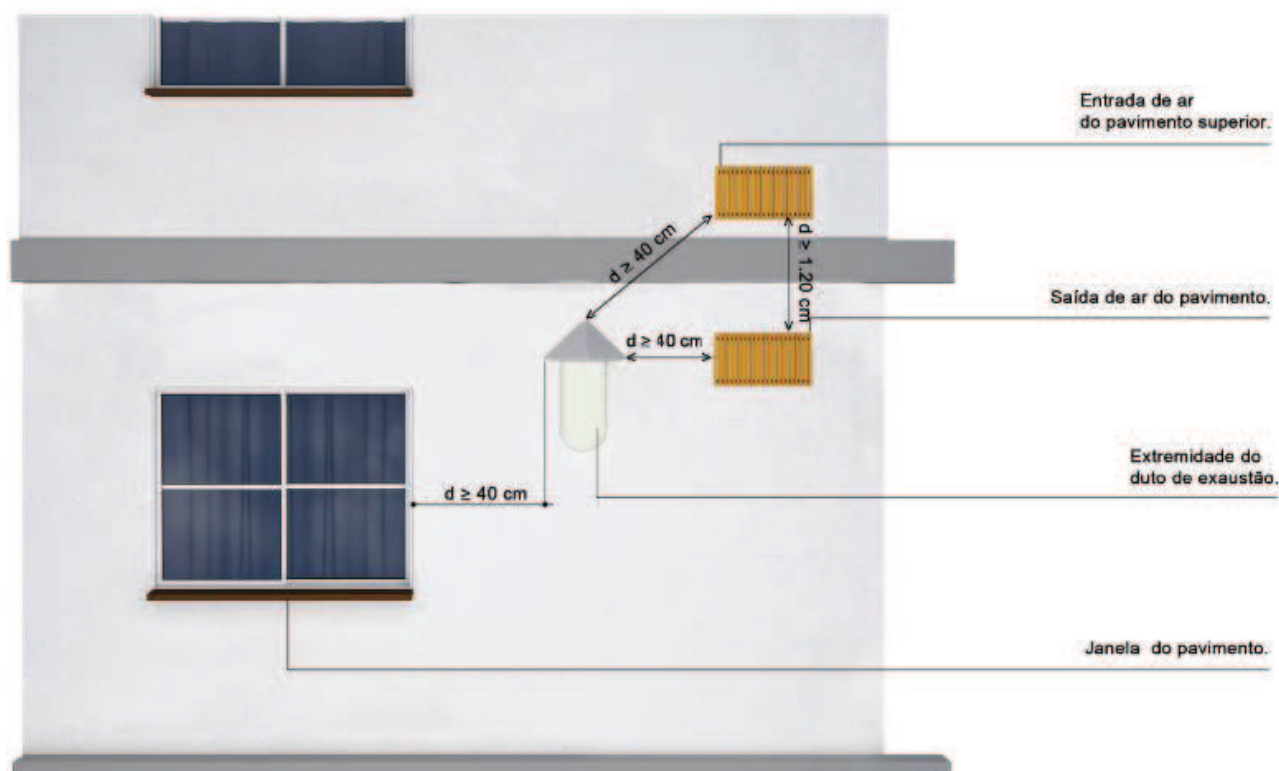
Ilustração da instalação de terminais de chaminé individual
